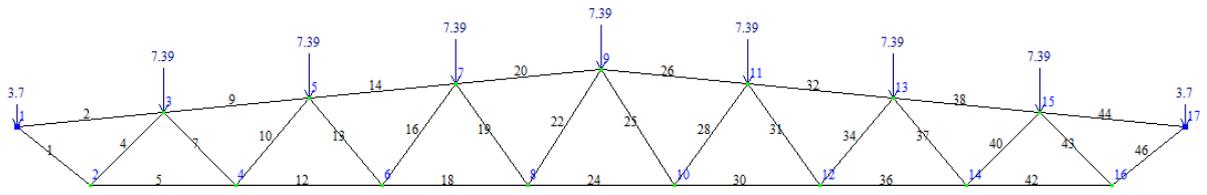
Загрузка 3 (от пирога кровли)
